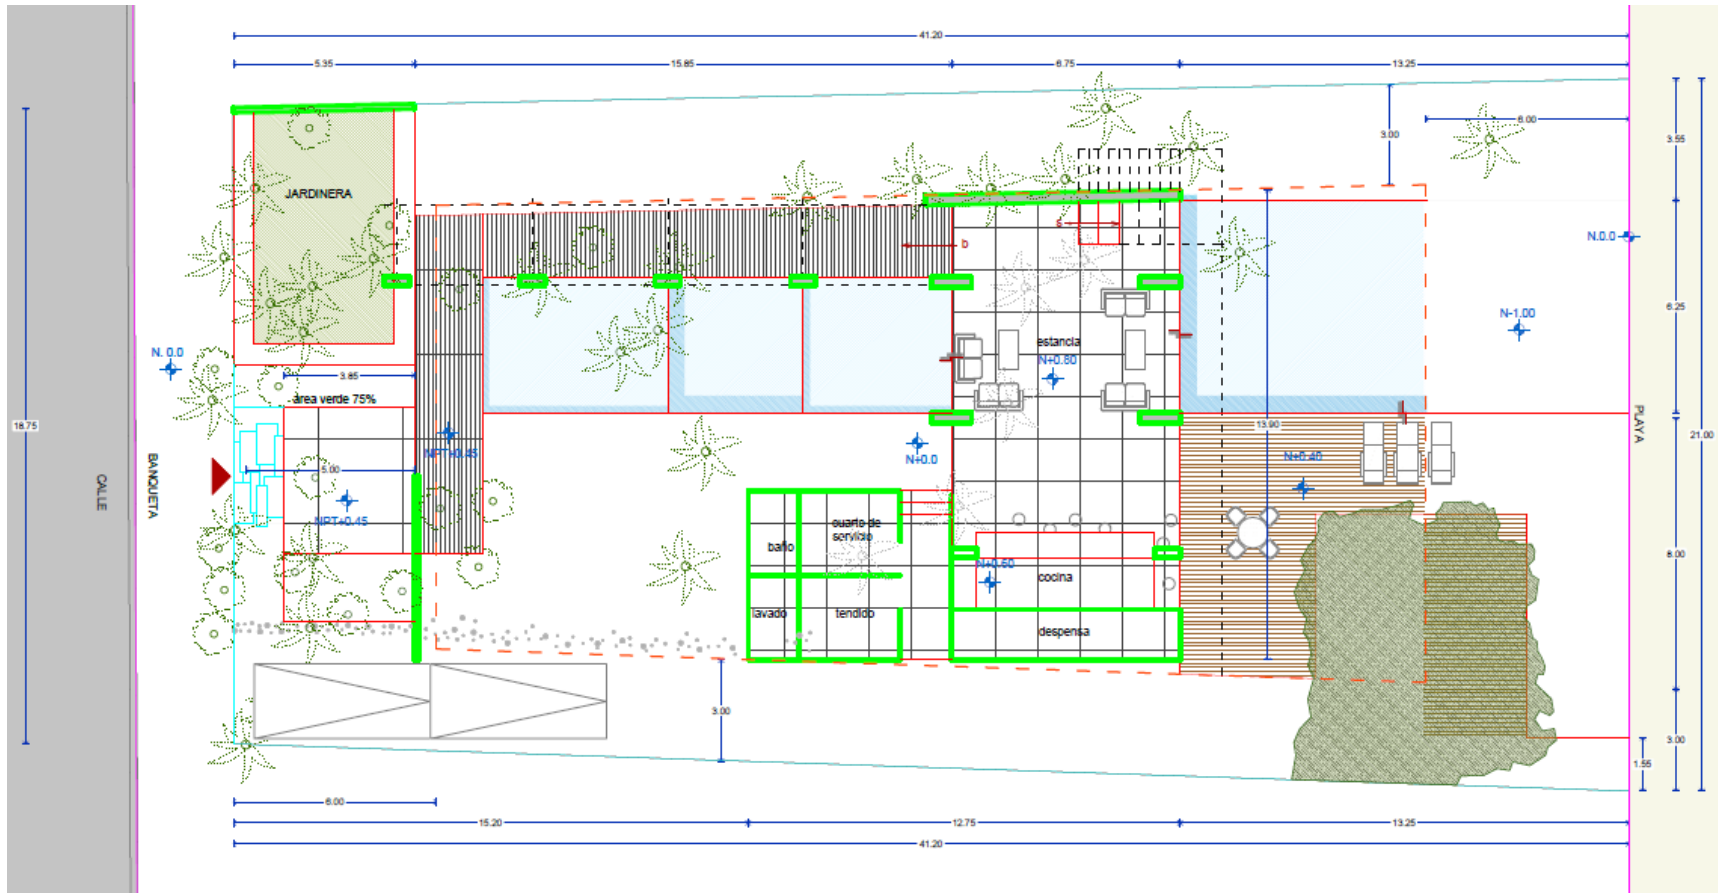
Plan maestro de la casa habitación (Planta Baja).
